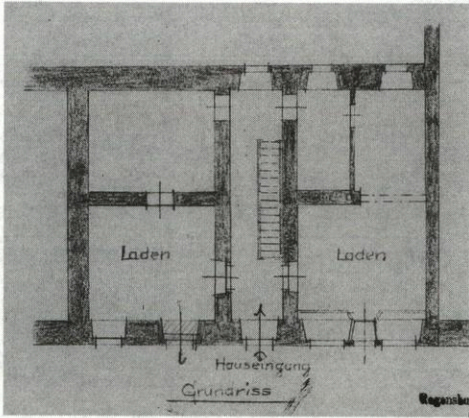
Obermünsterstraße 4, Grundriss 1930.
